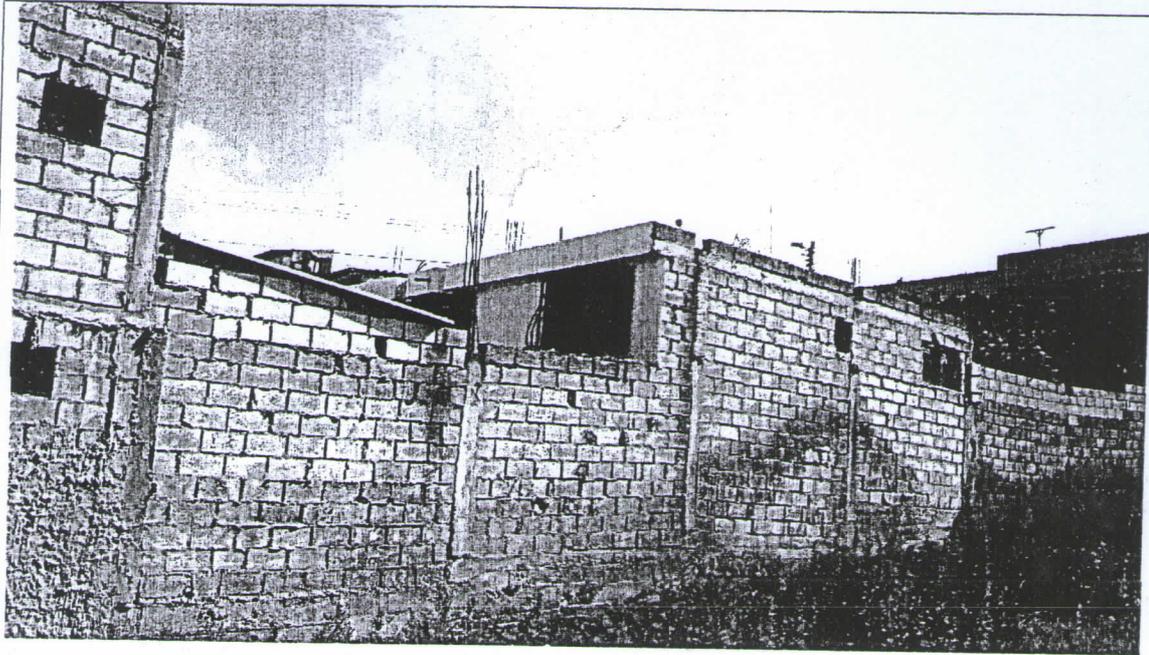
Vista de la fachada posterior o lindero Sur del inmueble, colinda con la propiedad del Sr. Teófilo Simbaña. Actualmente utilizado como servidumbre (pasaje peatonal).
